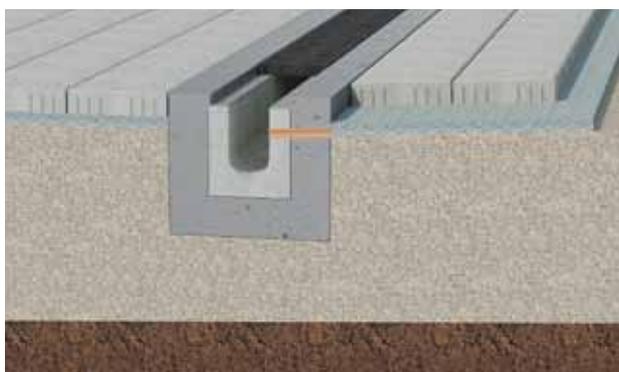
Caniveau de drainage avec enrobage en béton et drainage du lit de pose
